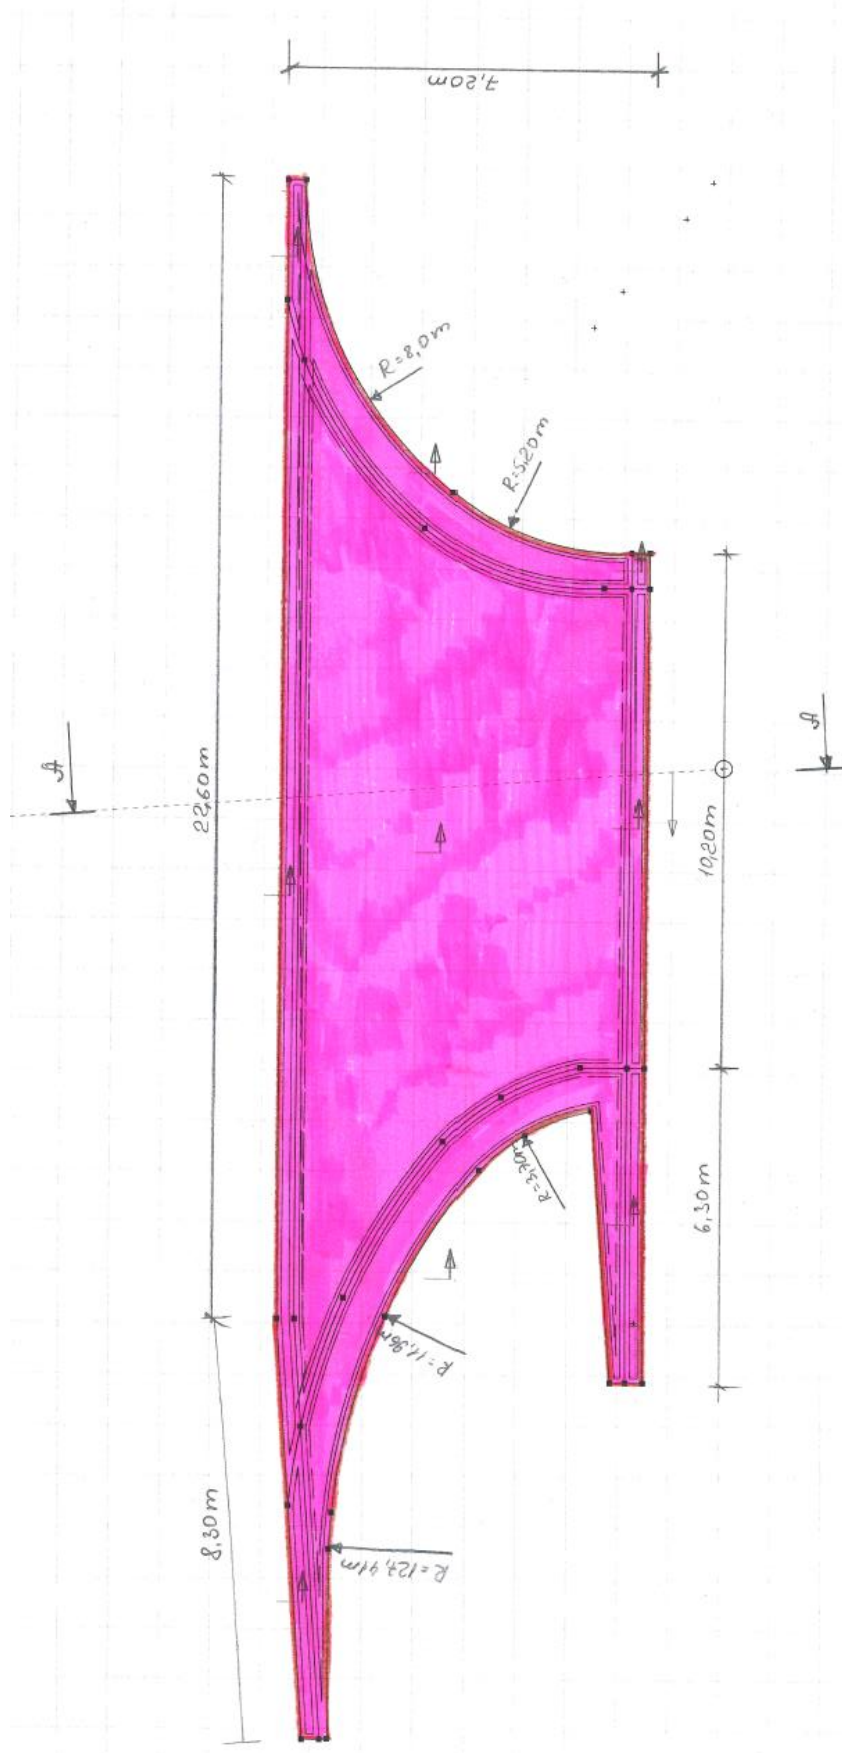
Skizze Grundriss der Brückenplatte
